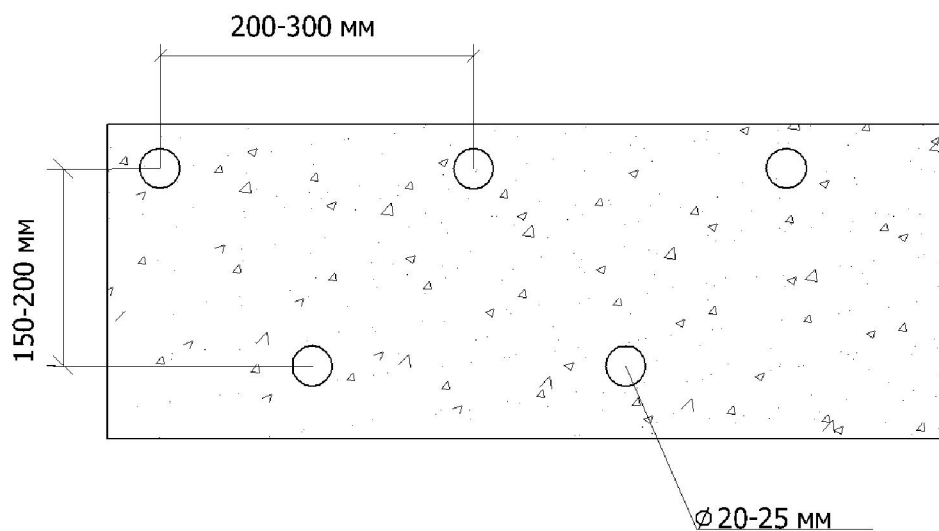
Гидроизоляция бетонного фундамента и отсечение капиллярного подсоса между бетонным фундаментом и стеной, выполненной из пористого материала, в существующей конструкции
